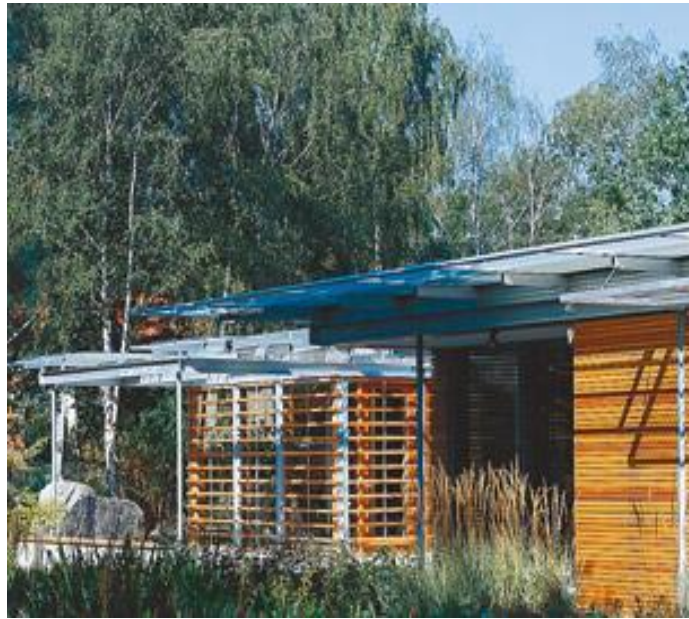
Горизонтально встановлені дерев'яні планки перетинають вертикальні сталеві стойки.
